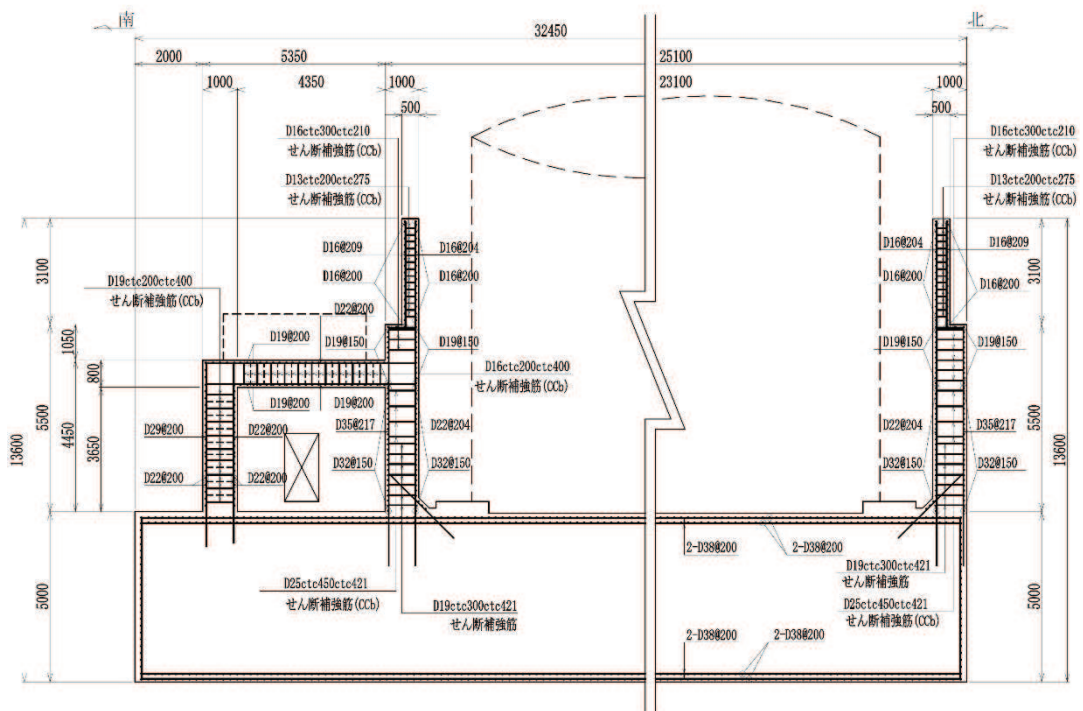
(2) 復水貯蔵タンク基礎 概略配筋図 (1-1 断面)
